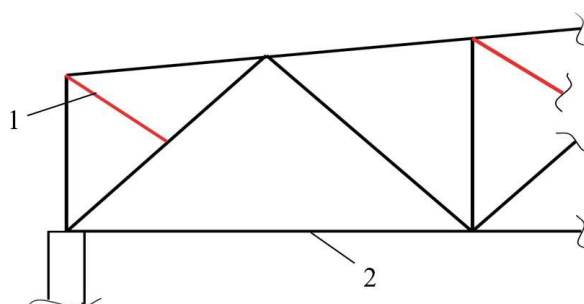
усиление сжатых раскосов: 1 — дополнительные раскосы, 2 — усиливаемая ферма
